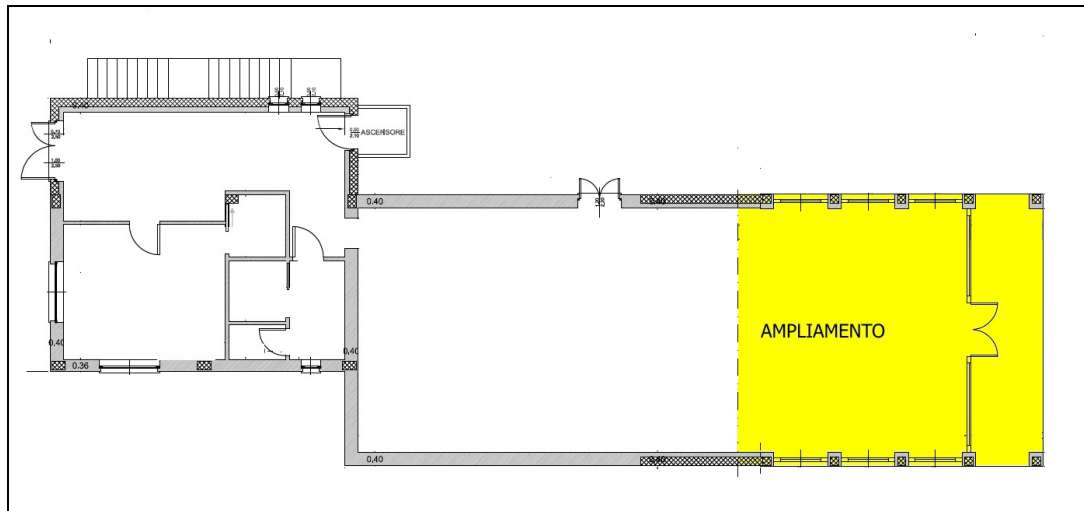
Progetto: pianta del piano terra (tratta dalla Tavola n. 5)
